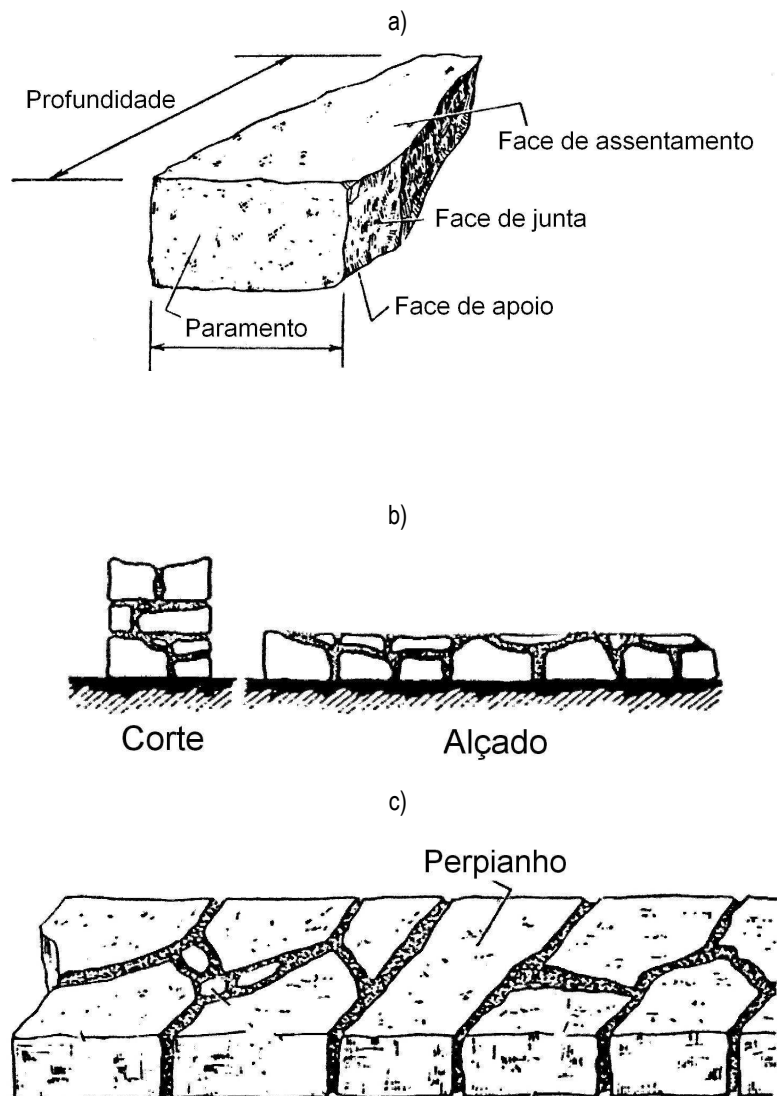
Aparelhos tradicionais e detalhe de elevação de uma parede em pedra aparelhada
